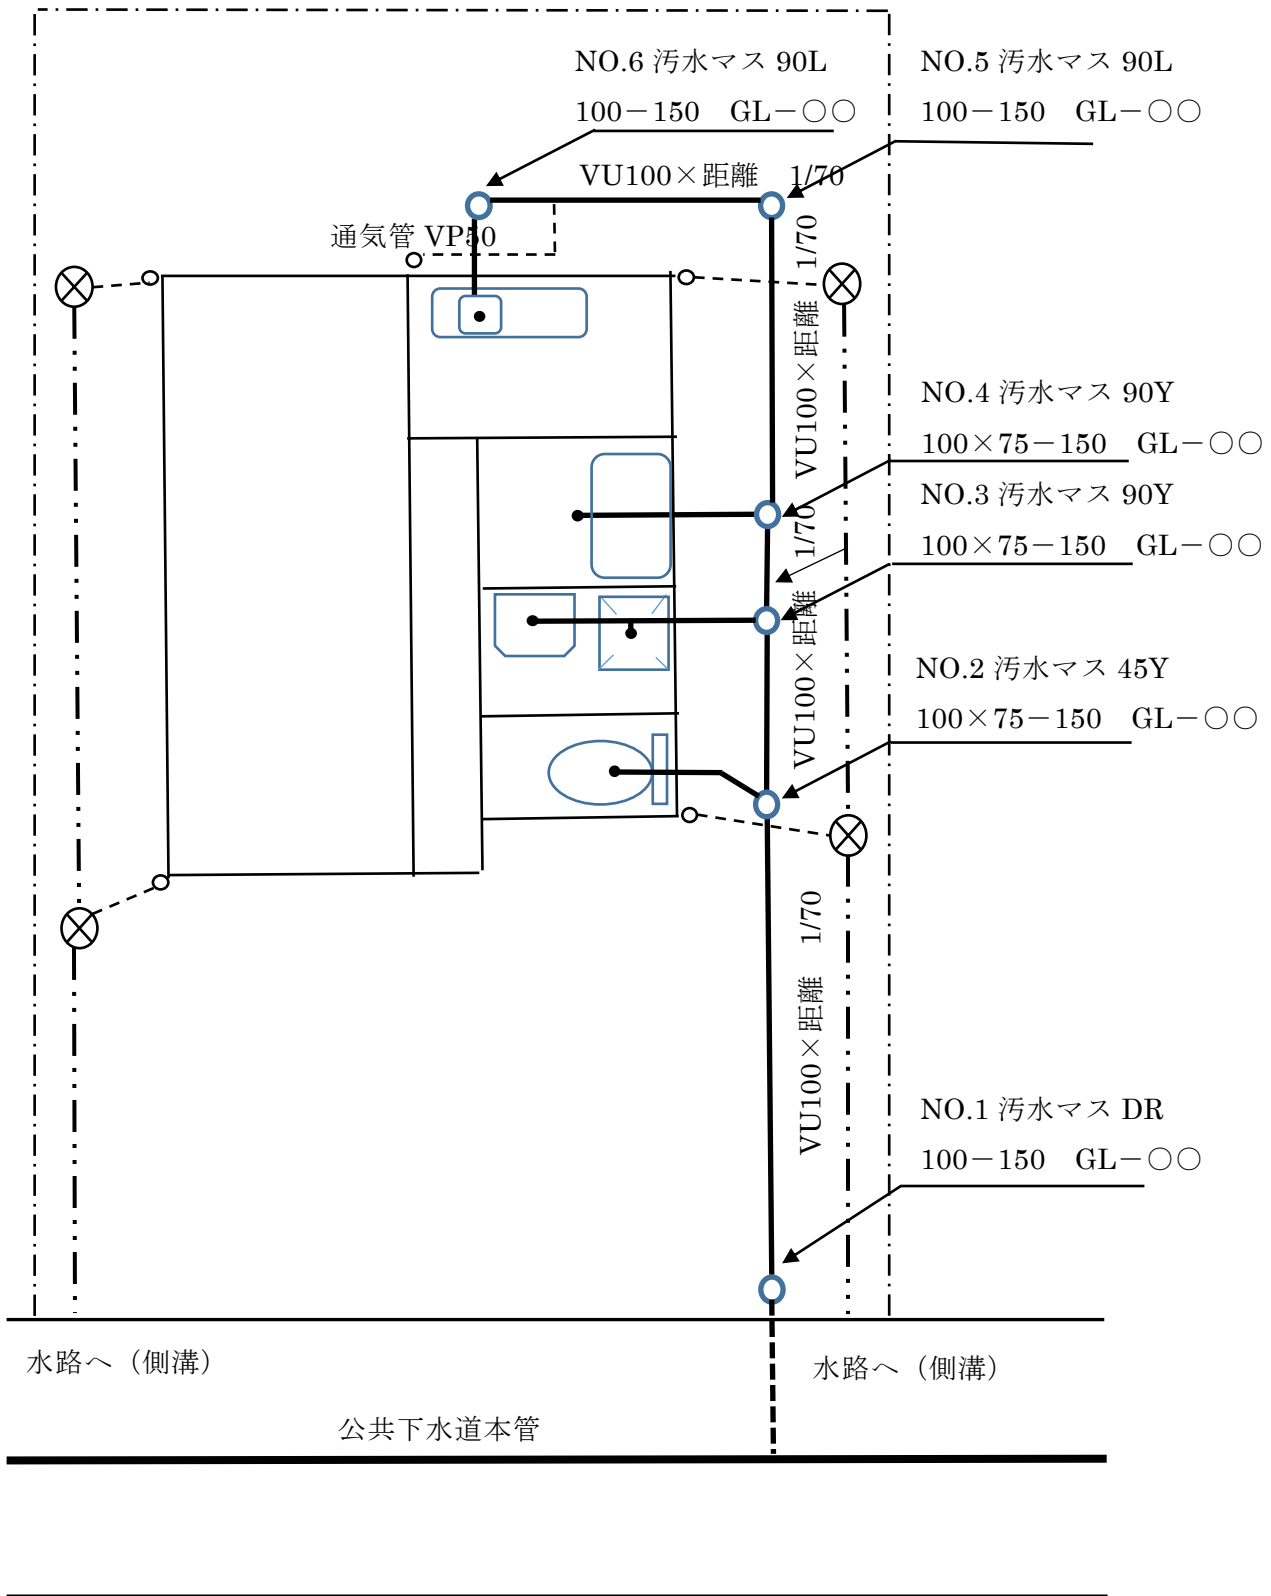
排水設備標準図(例 1) 平面図縮尺 1/200
